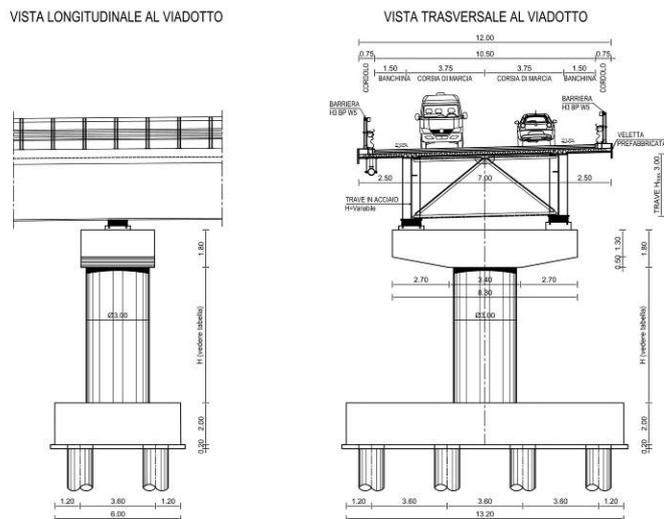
Sezione trasversale e longitudinale del cavalcavia San Giuliano.
